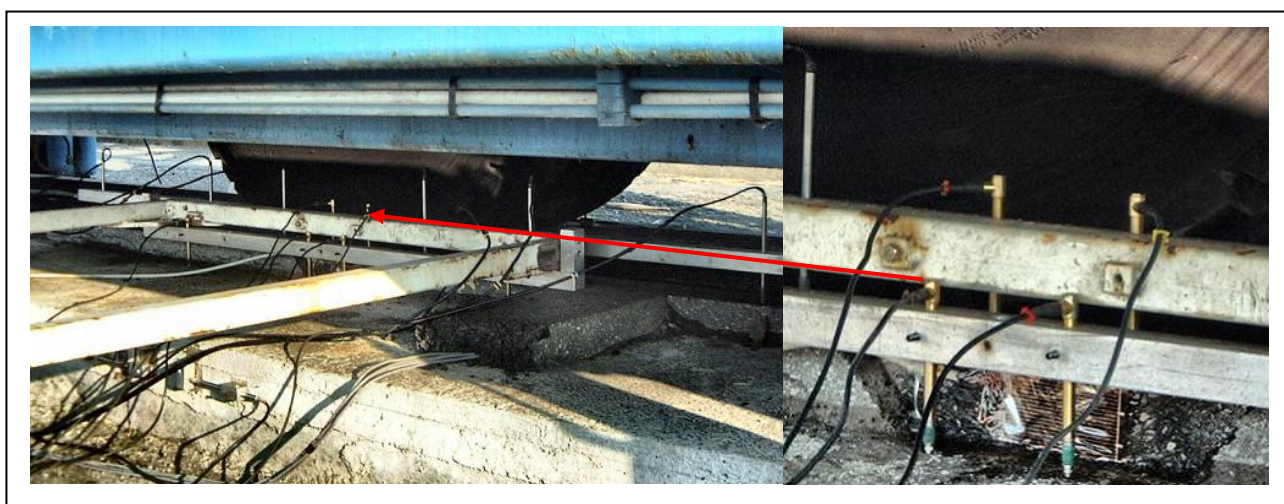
Capteurs LVDT sur la poutre installée pour mesurer les déflexions au passage de la charge
